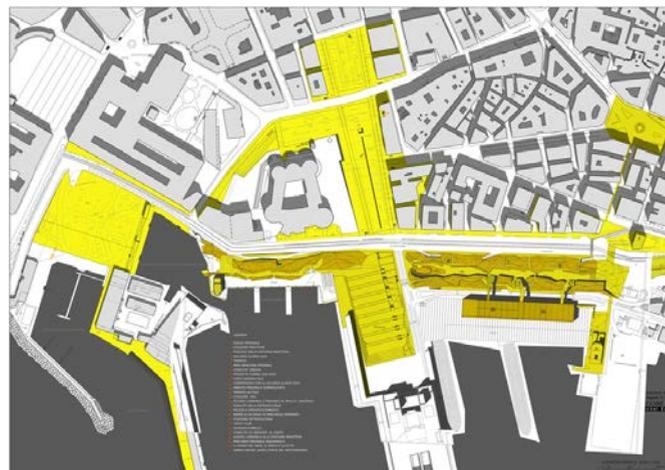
Schema planimetrico di progetto del waterfront storico
